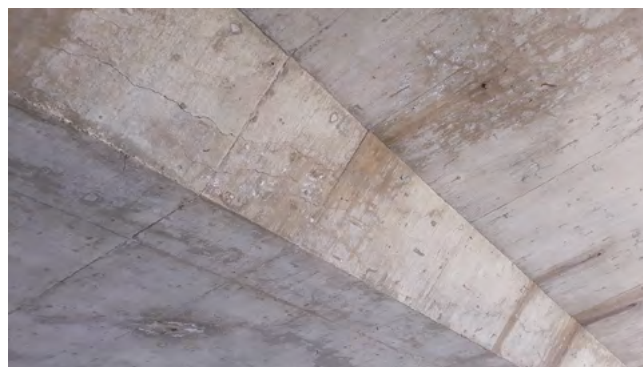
Fisuración longitudinal en el alma de una losa postesada.
